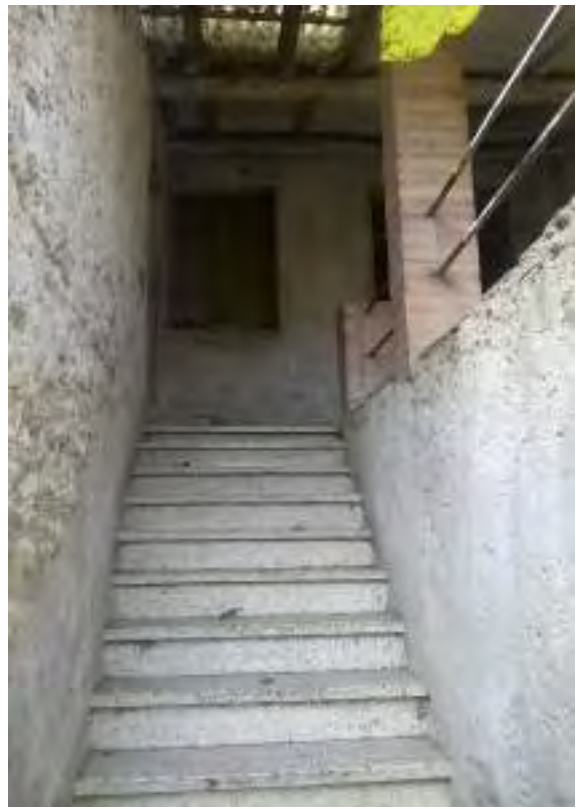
prospetto posteriore- "B"- UNITA' COLLABENTE (Fg. 150, p,lla 144, sub.1)
